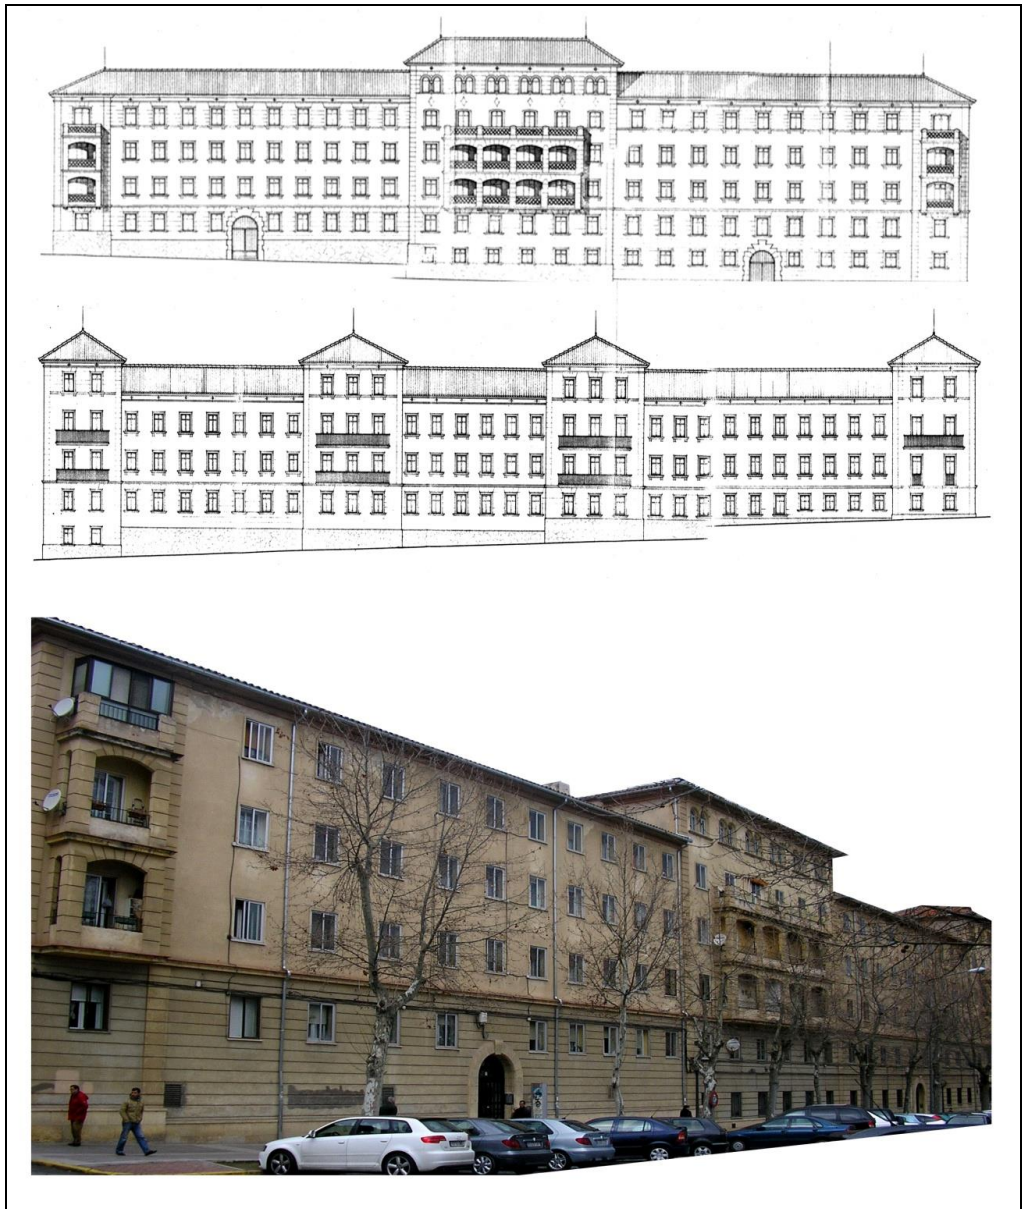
Viviendas Militares. Fachada principal, Fachada posterior y vista actual.
